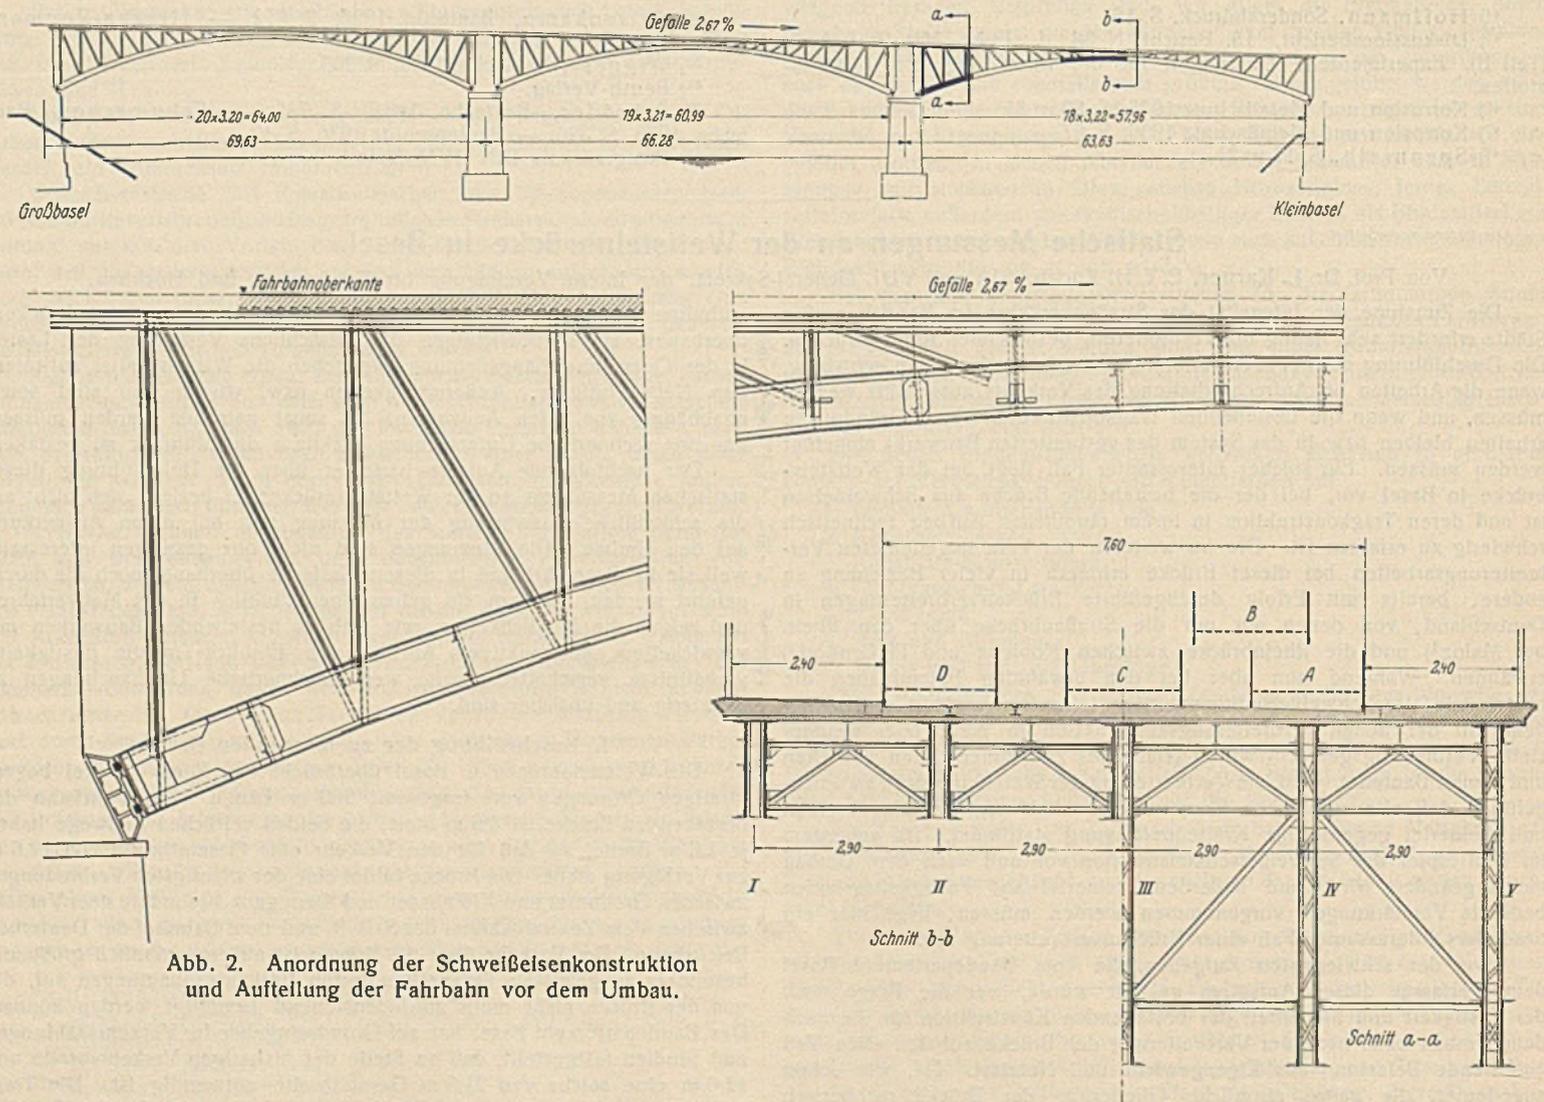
Anordnung der Schweißeisenkonstruktion und Aufteilung der Fahrbahn vor dem Umbau.
